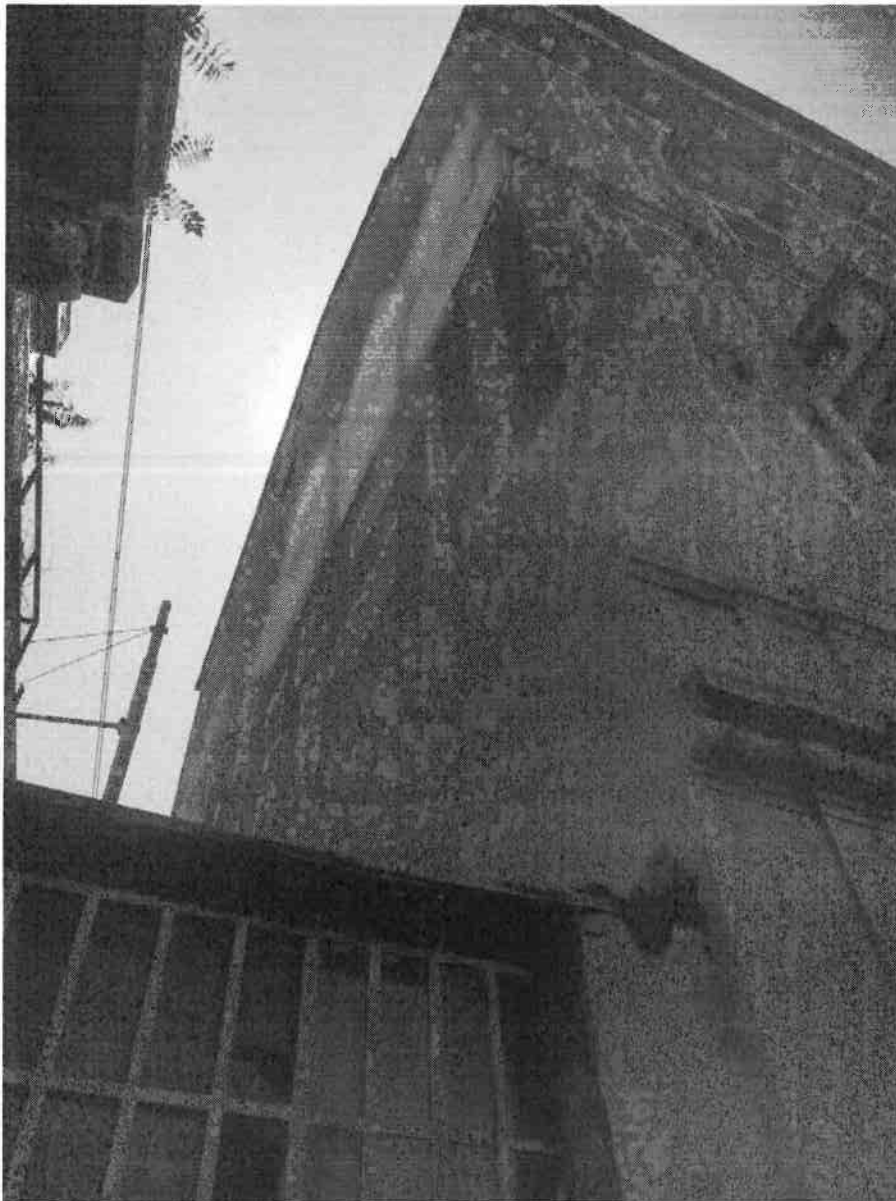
situazione prospetto lato nord-est durante il sopralluogo del 18.05.2021
